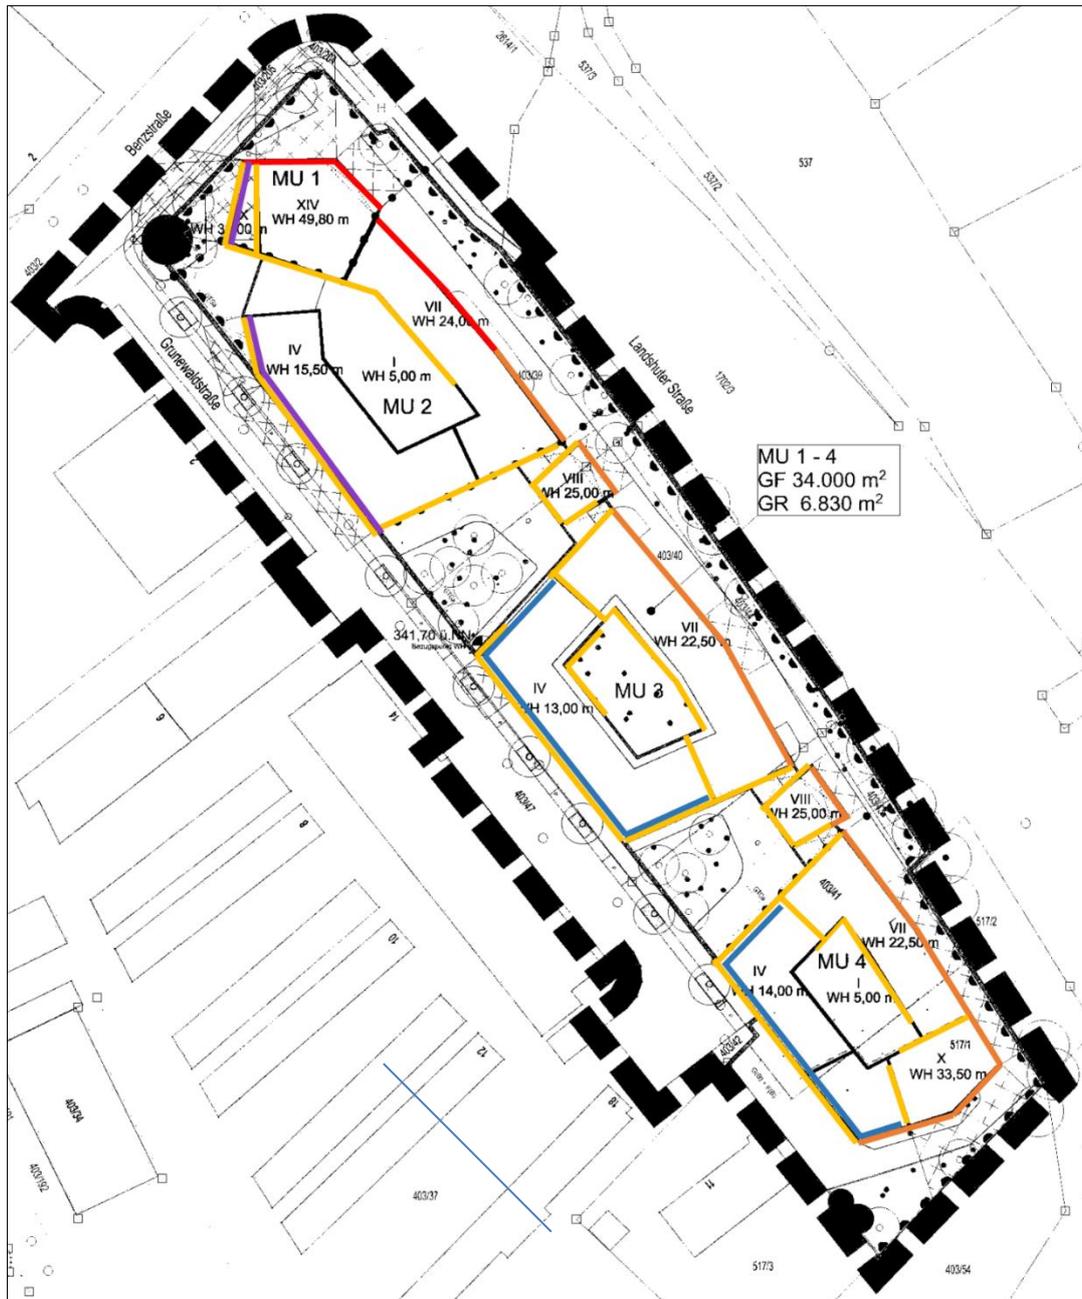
Fassadenkennzeichnung für die Vorschläge für Festsetzungen zum Bebauungsplan, stockwerksweise Auslegung möglich.
